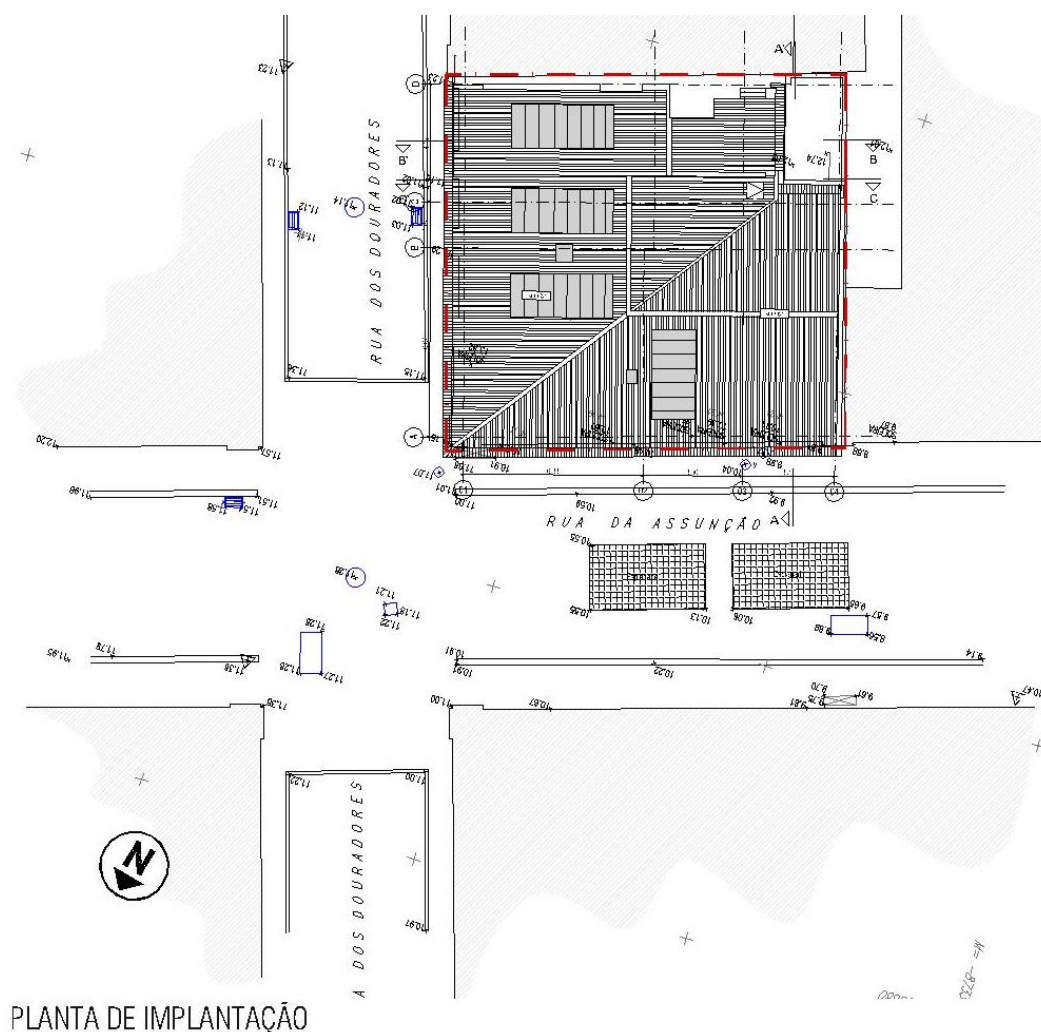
Planta de Implantação. (Saraiva & Associados, 2017a).
